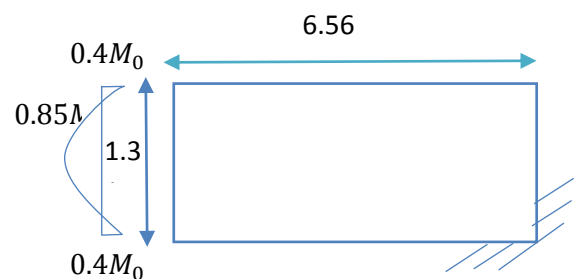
Schéma statique de la dalle pleine (D2)
